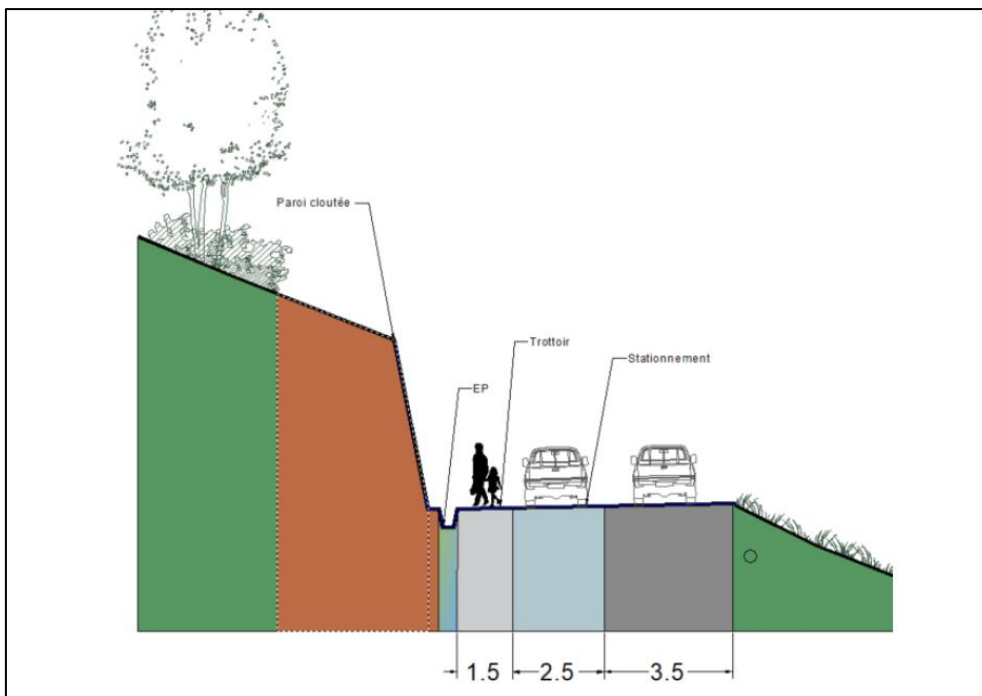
Profil en travers rue des Coteaux sur l'intercepteur
